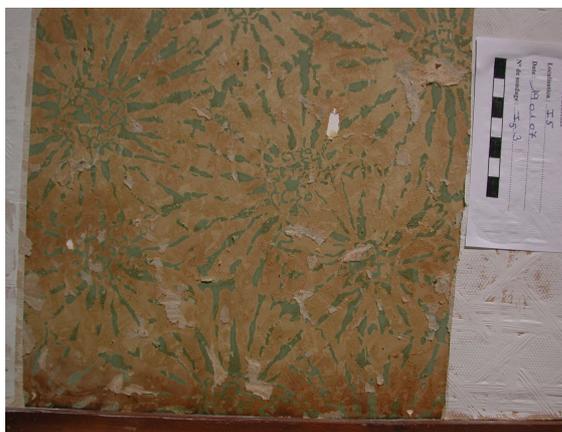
Papier peint du plafond. Ce papier est fortement lacunaire au niveau des caissons de la salle à manger.
